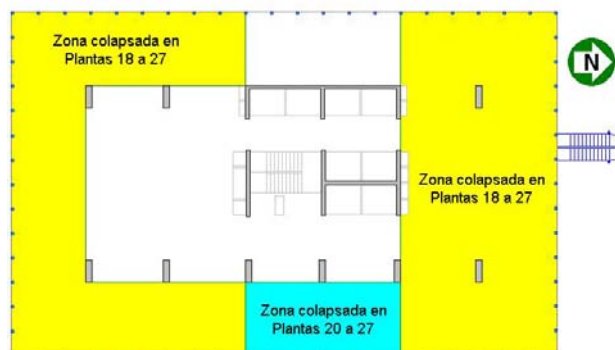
Zonas colapsadas sobre el nivel de la Planta Técnica 2
